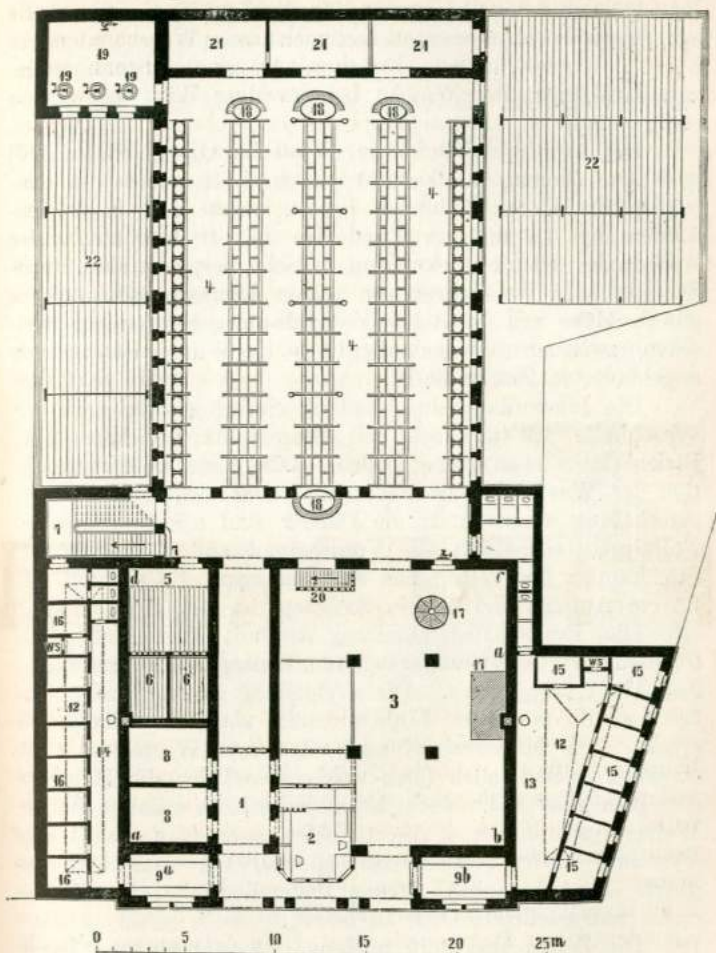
Wasch- und Badeanstalt in Metz (Grundriss).
